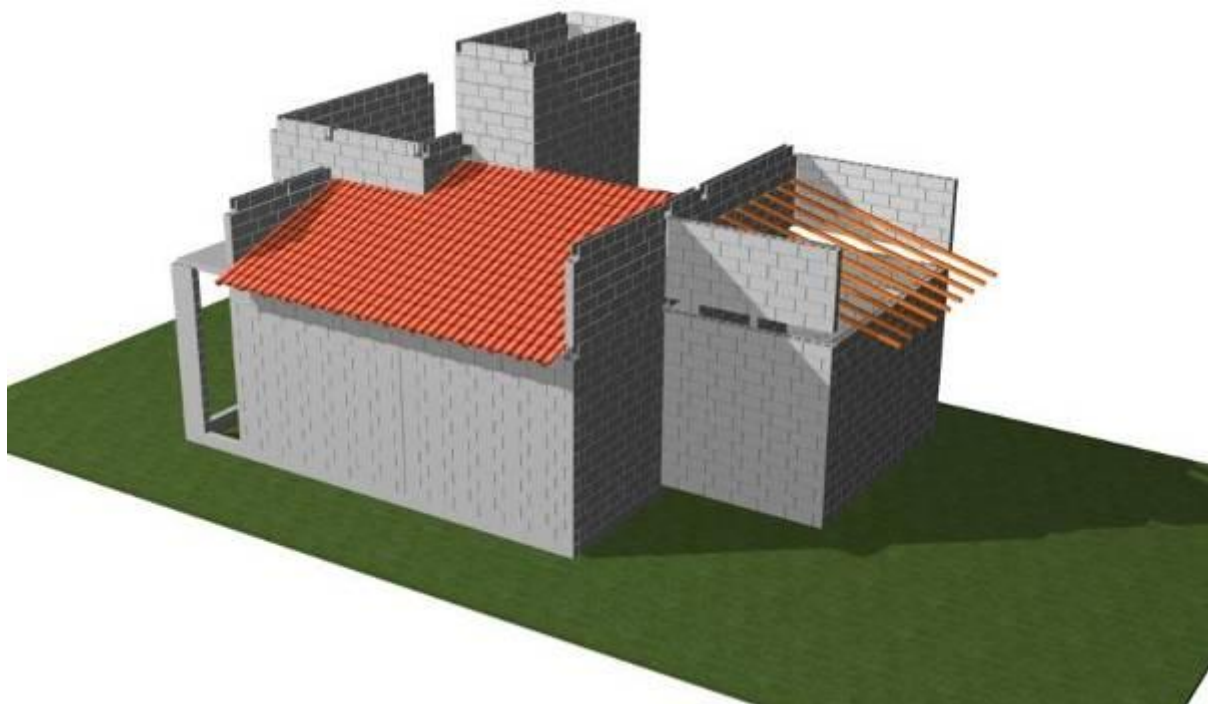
Instalação dos caibros de sustentação do telhado.
